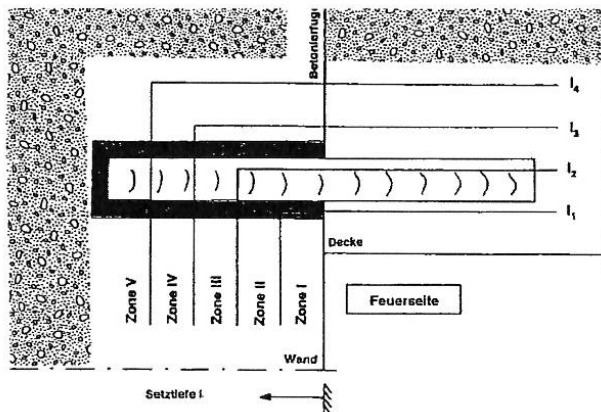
Schematische Darstellung der Bewehrungsanschlussvariante „Verankerung“
